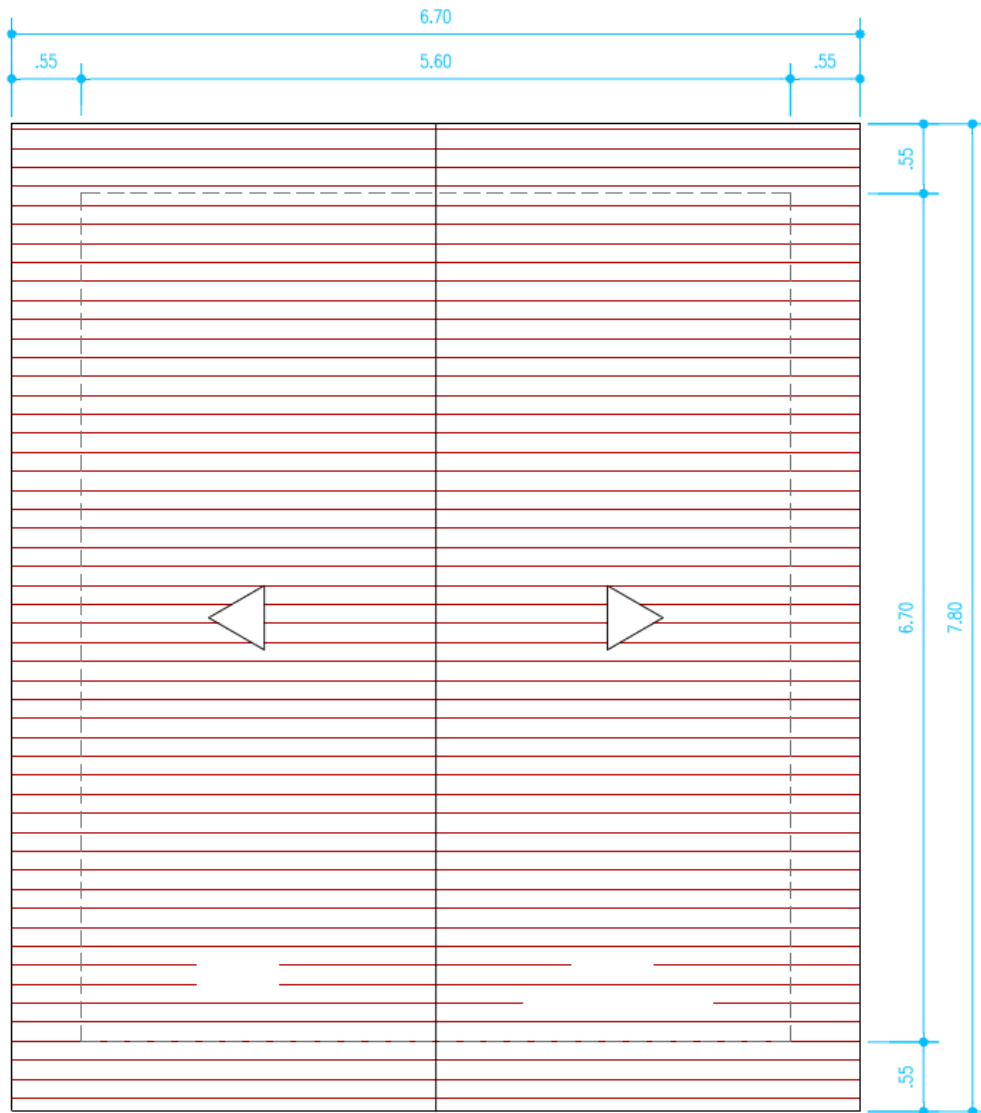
Planta cotada da cobertura - Caso de estudo A
